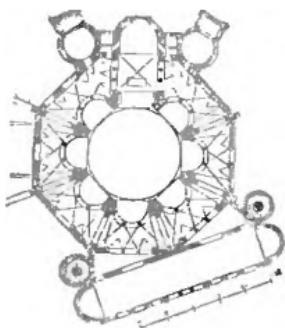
Ravenna, Grundriss der Kirche San Vitale.
